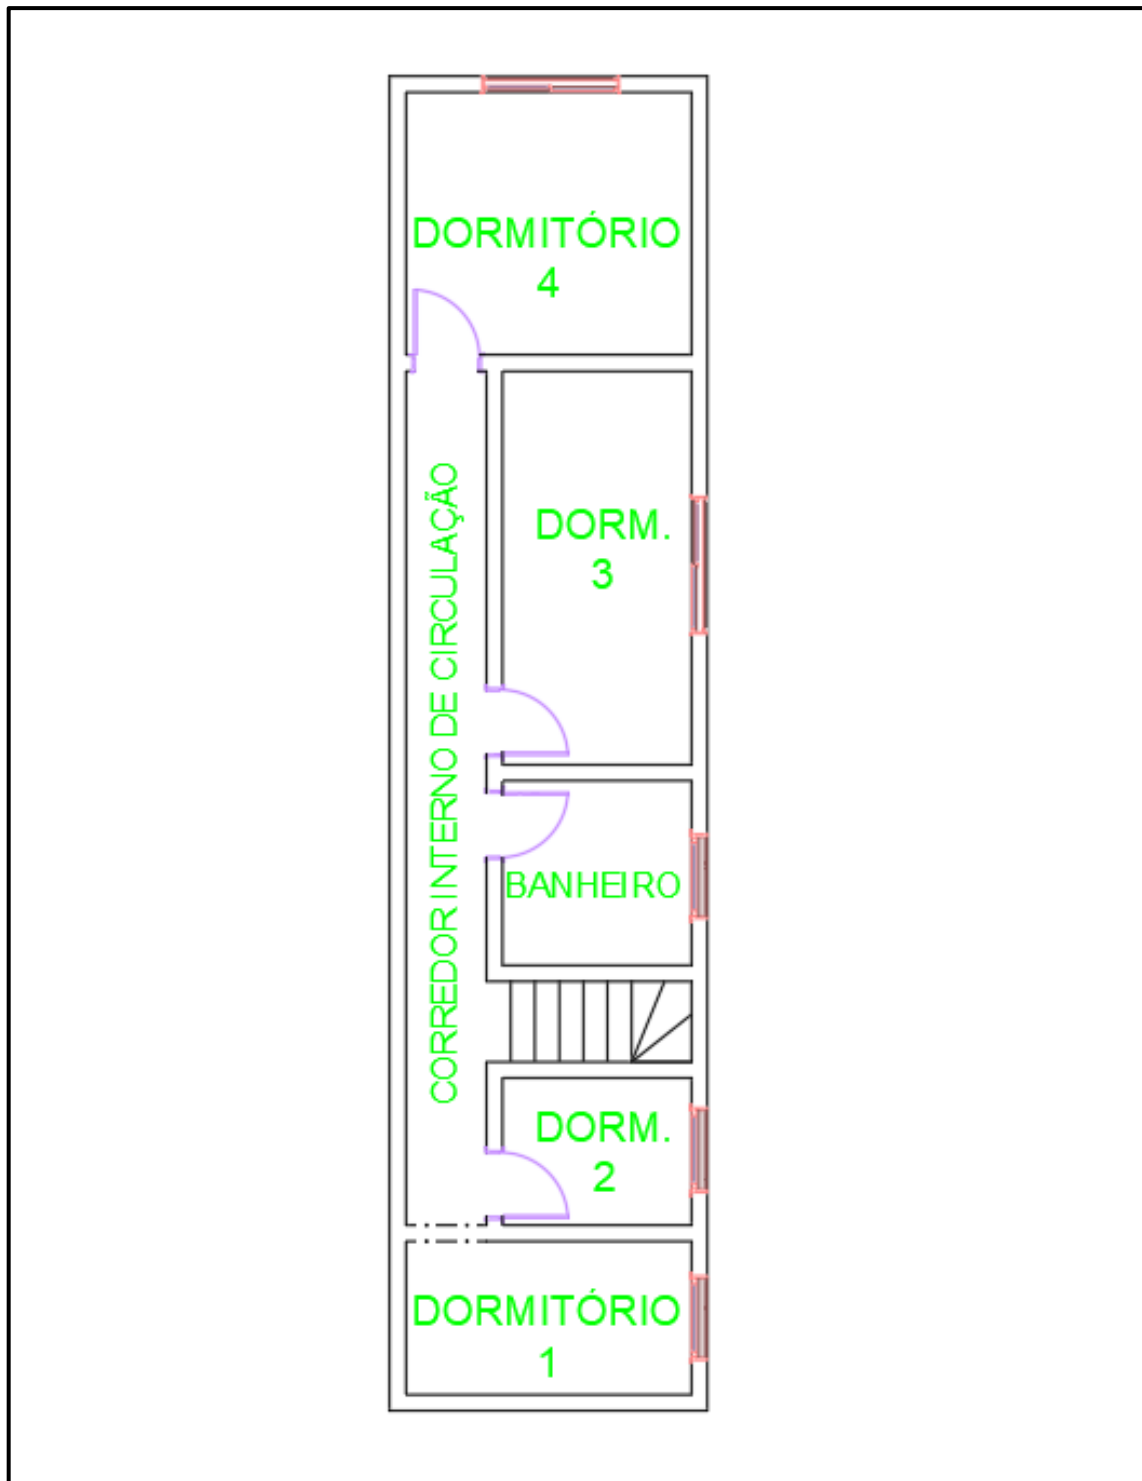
Dormitório 1 erigido no 2º pavimento do terreno avaliando
